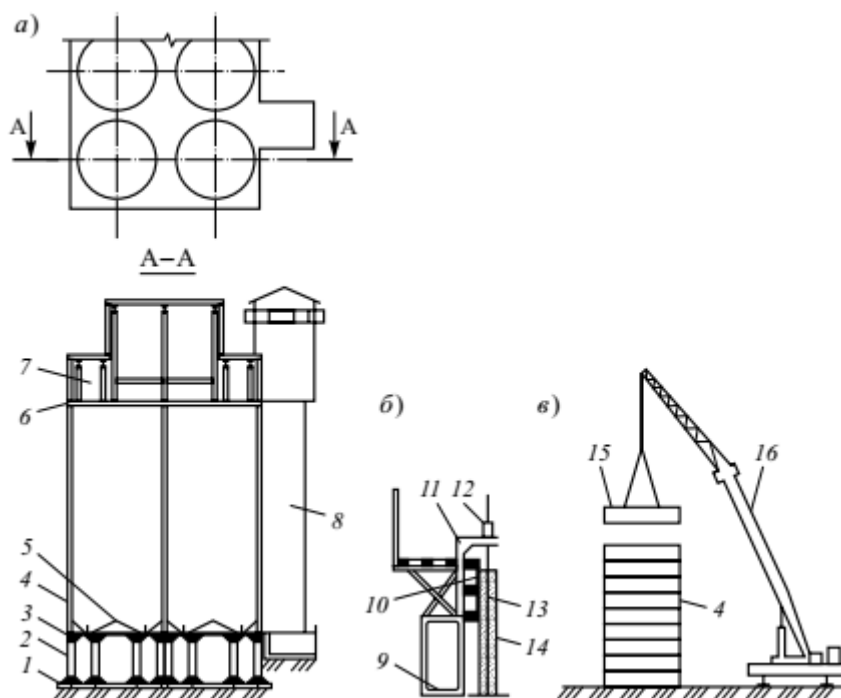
Зведення залізобетонних силосів: а – конструкція силосу (план та розріз); б, в - пристрій монолітних банок і збірних залізобетонних силосів; 1 – фундаментна плита; 2 – несучі колони; 3, 6 – підсилосне та надсилосне перекриття; 4 – силосна банка; 5 – укоси; 7 – надсилосна галерея; 8 – сходові клітки; 9 – риштування для затирання стін; 10 – опалубка; 11 – домкратна рама; 12 – домкрат; 13 – домкратний стрижень; 14 – стіна; 15 – кільце; 16 – кран
